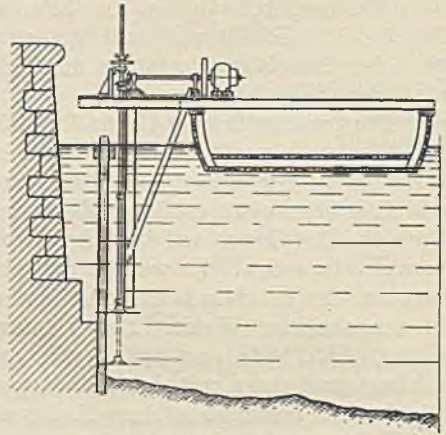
Befestigung einer Grundsäge an einem Schiff.
